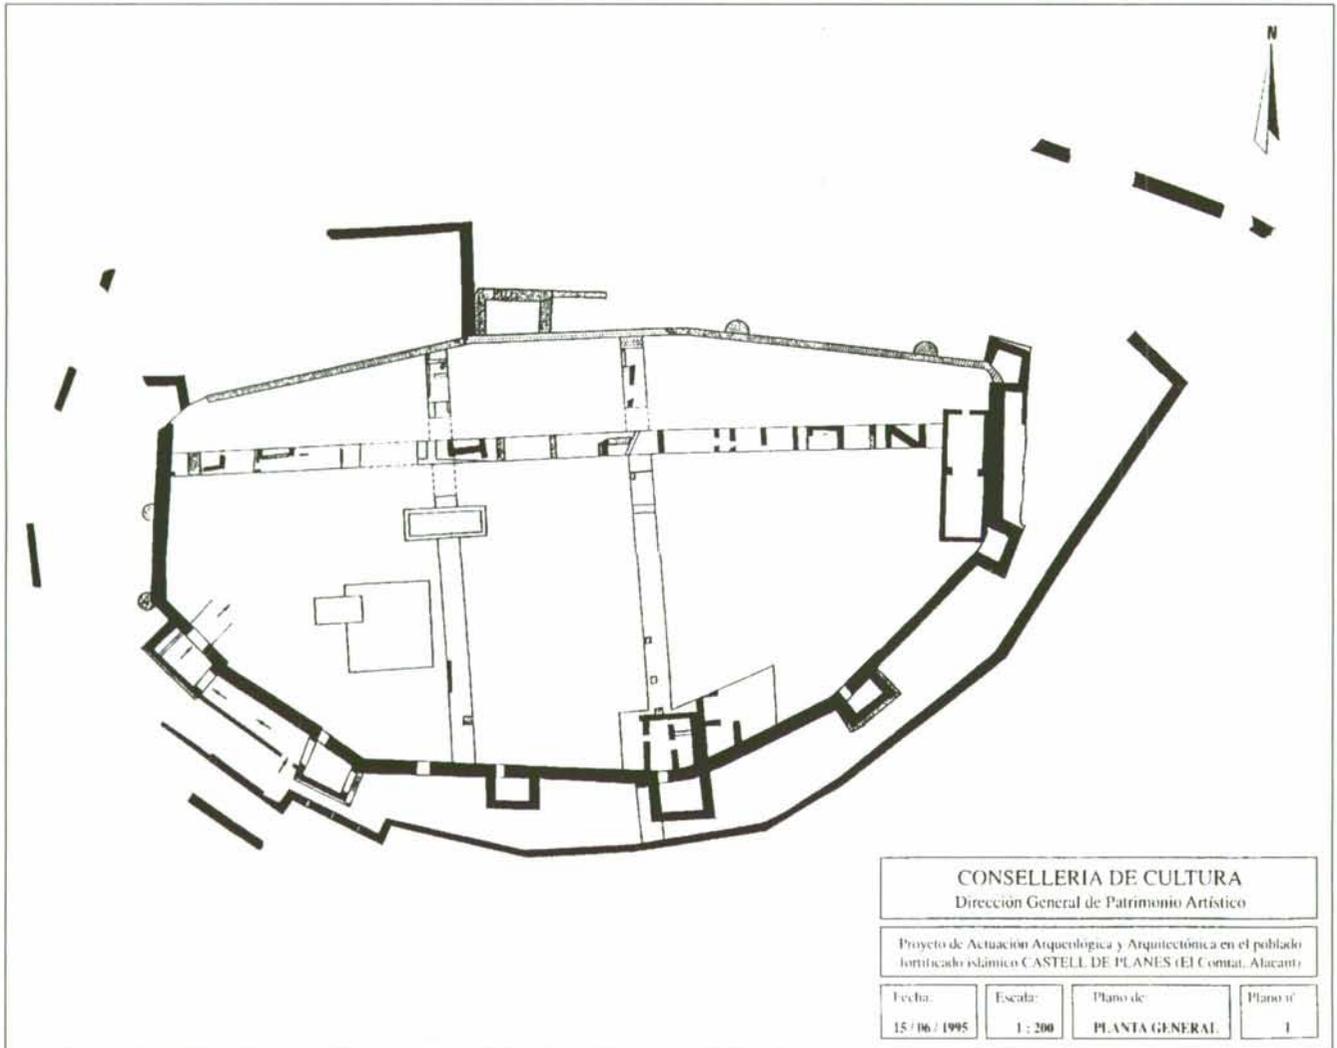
Planta del Castell de Planes de la Baronía con las estructuras exhumadas en la actuación arqueológica preliminar.
